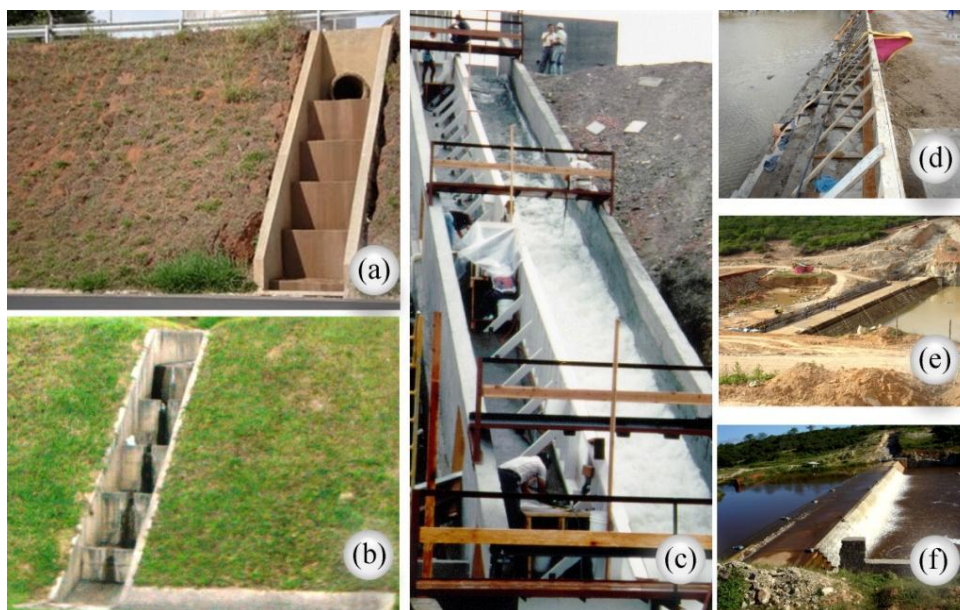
Canais e vertedores em degraus construídos com diferentes materiais: (a,b) Estruturas de concreto armado; (c) Canal em degraus formado por peças pré-moldadas; (d,e,f) Barragem construída com concreto compactado a rolo. Fonte: (c) – Frizell (1992); (d,e,f) – Imagens cedidas por Antônio G. Simões de Oliveira e Paulo R. M. Simões.
